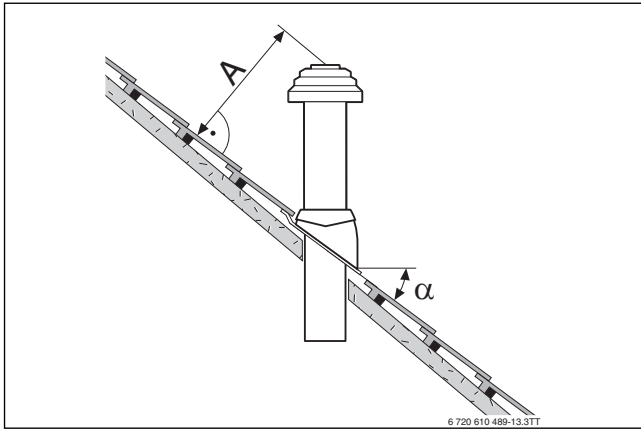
Abstandsmaße und Dachneigungen bei Schrägdach
